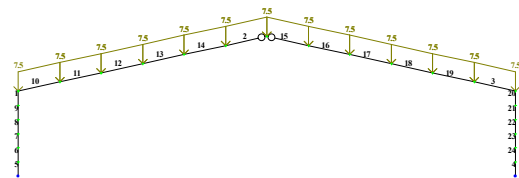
Расчетная схема рамы под воздействием расчетных нагрузок
